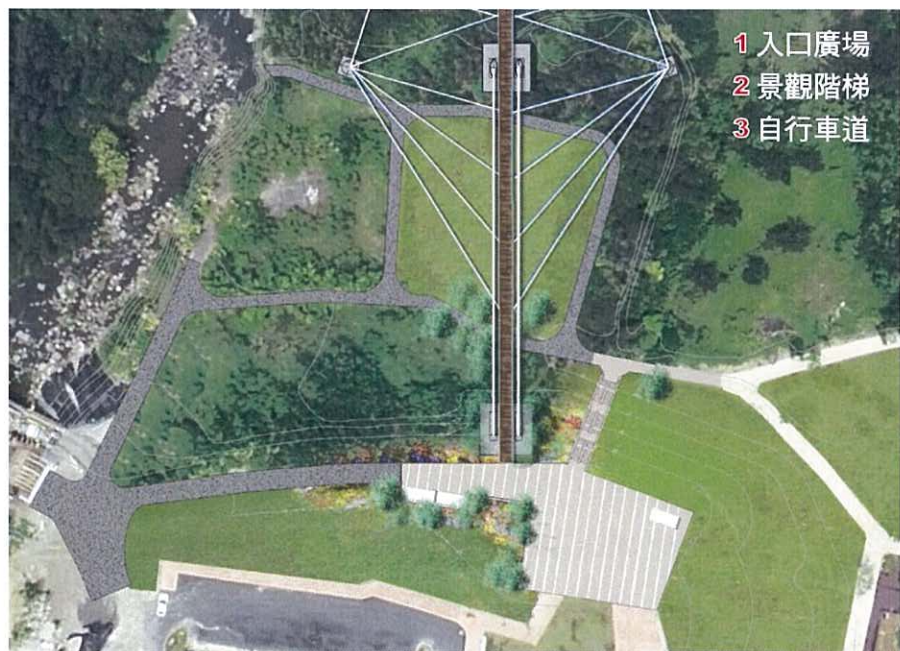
跨河休憩路廊兩岸入口廣場(右岸)平面圖
